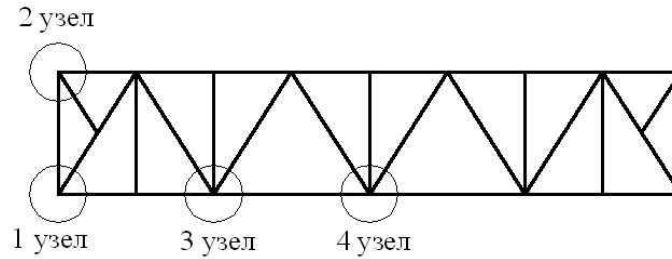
Схема к расчету и конструированию узлов фермы
